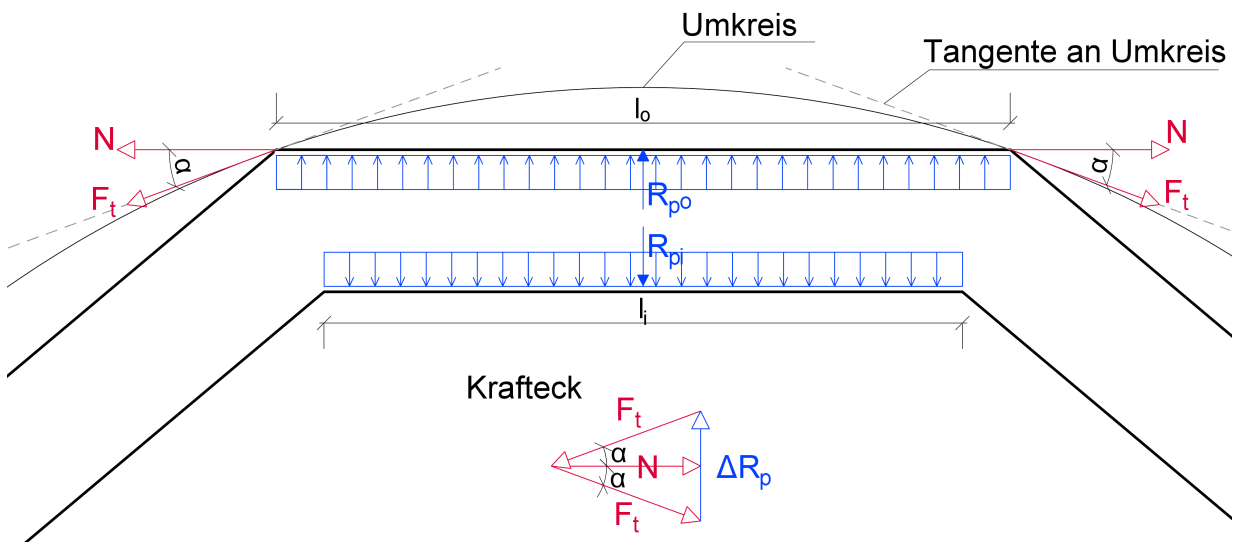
Statisches System eines Doppelwandelements im Grundriss unter Frischbetondruck bei einem regelmäßigen polygonalen Segmentgrundriss und Kopplung in der Außenschale inklusive Krafteck
